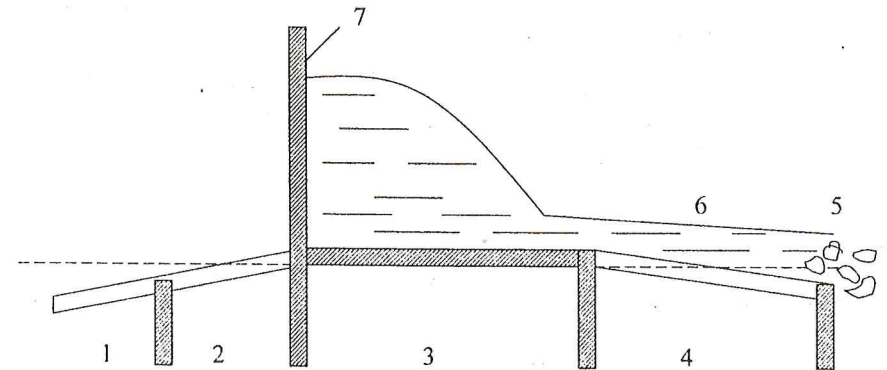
Схема водоспуска: 1-предпунное сооружение; 2-пунная часть; 3-водобойная часть; 4-сливной пол; 5-рисберма; 6-нижний бьеф; 7-шпунтовая стенка (дамба)
